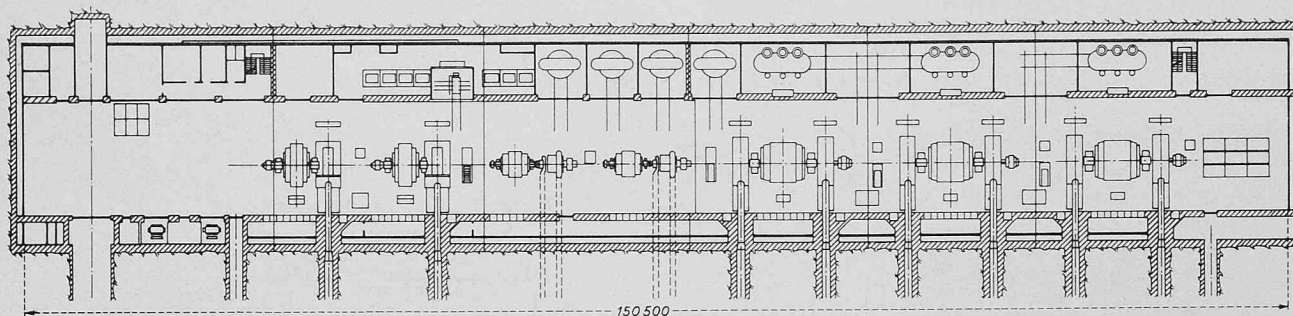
Grundriss des Maschinensaales im Kraftwerk Tierfeld
